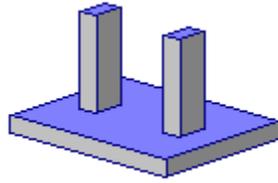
Zapata Combinada, Concreto, Rectangular, Interna
